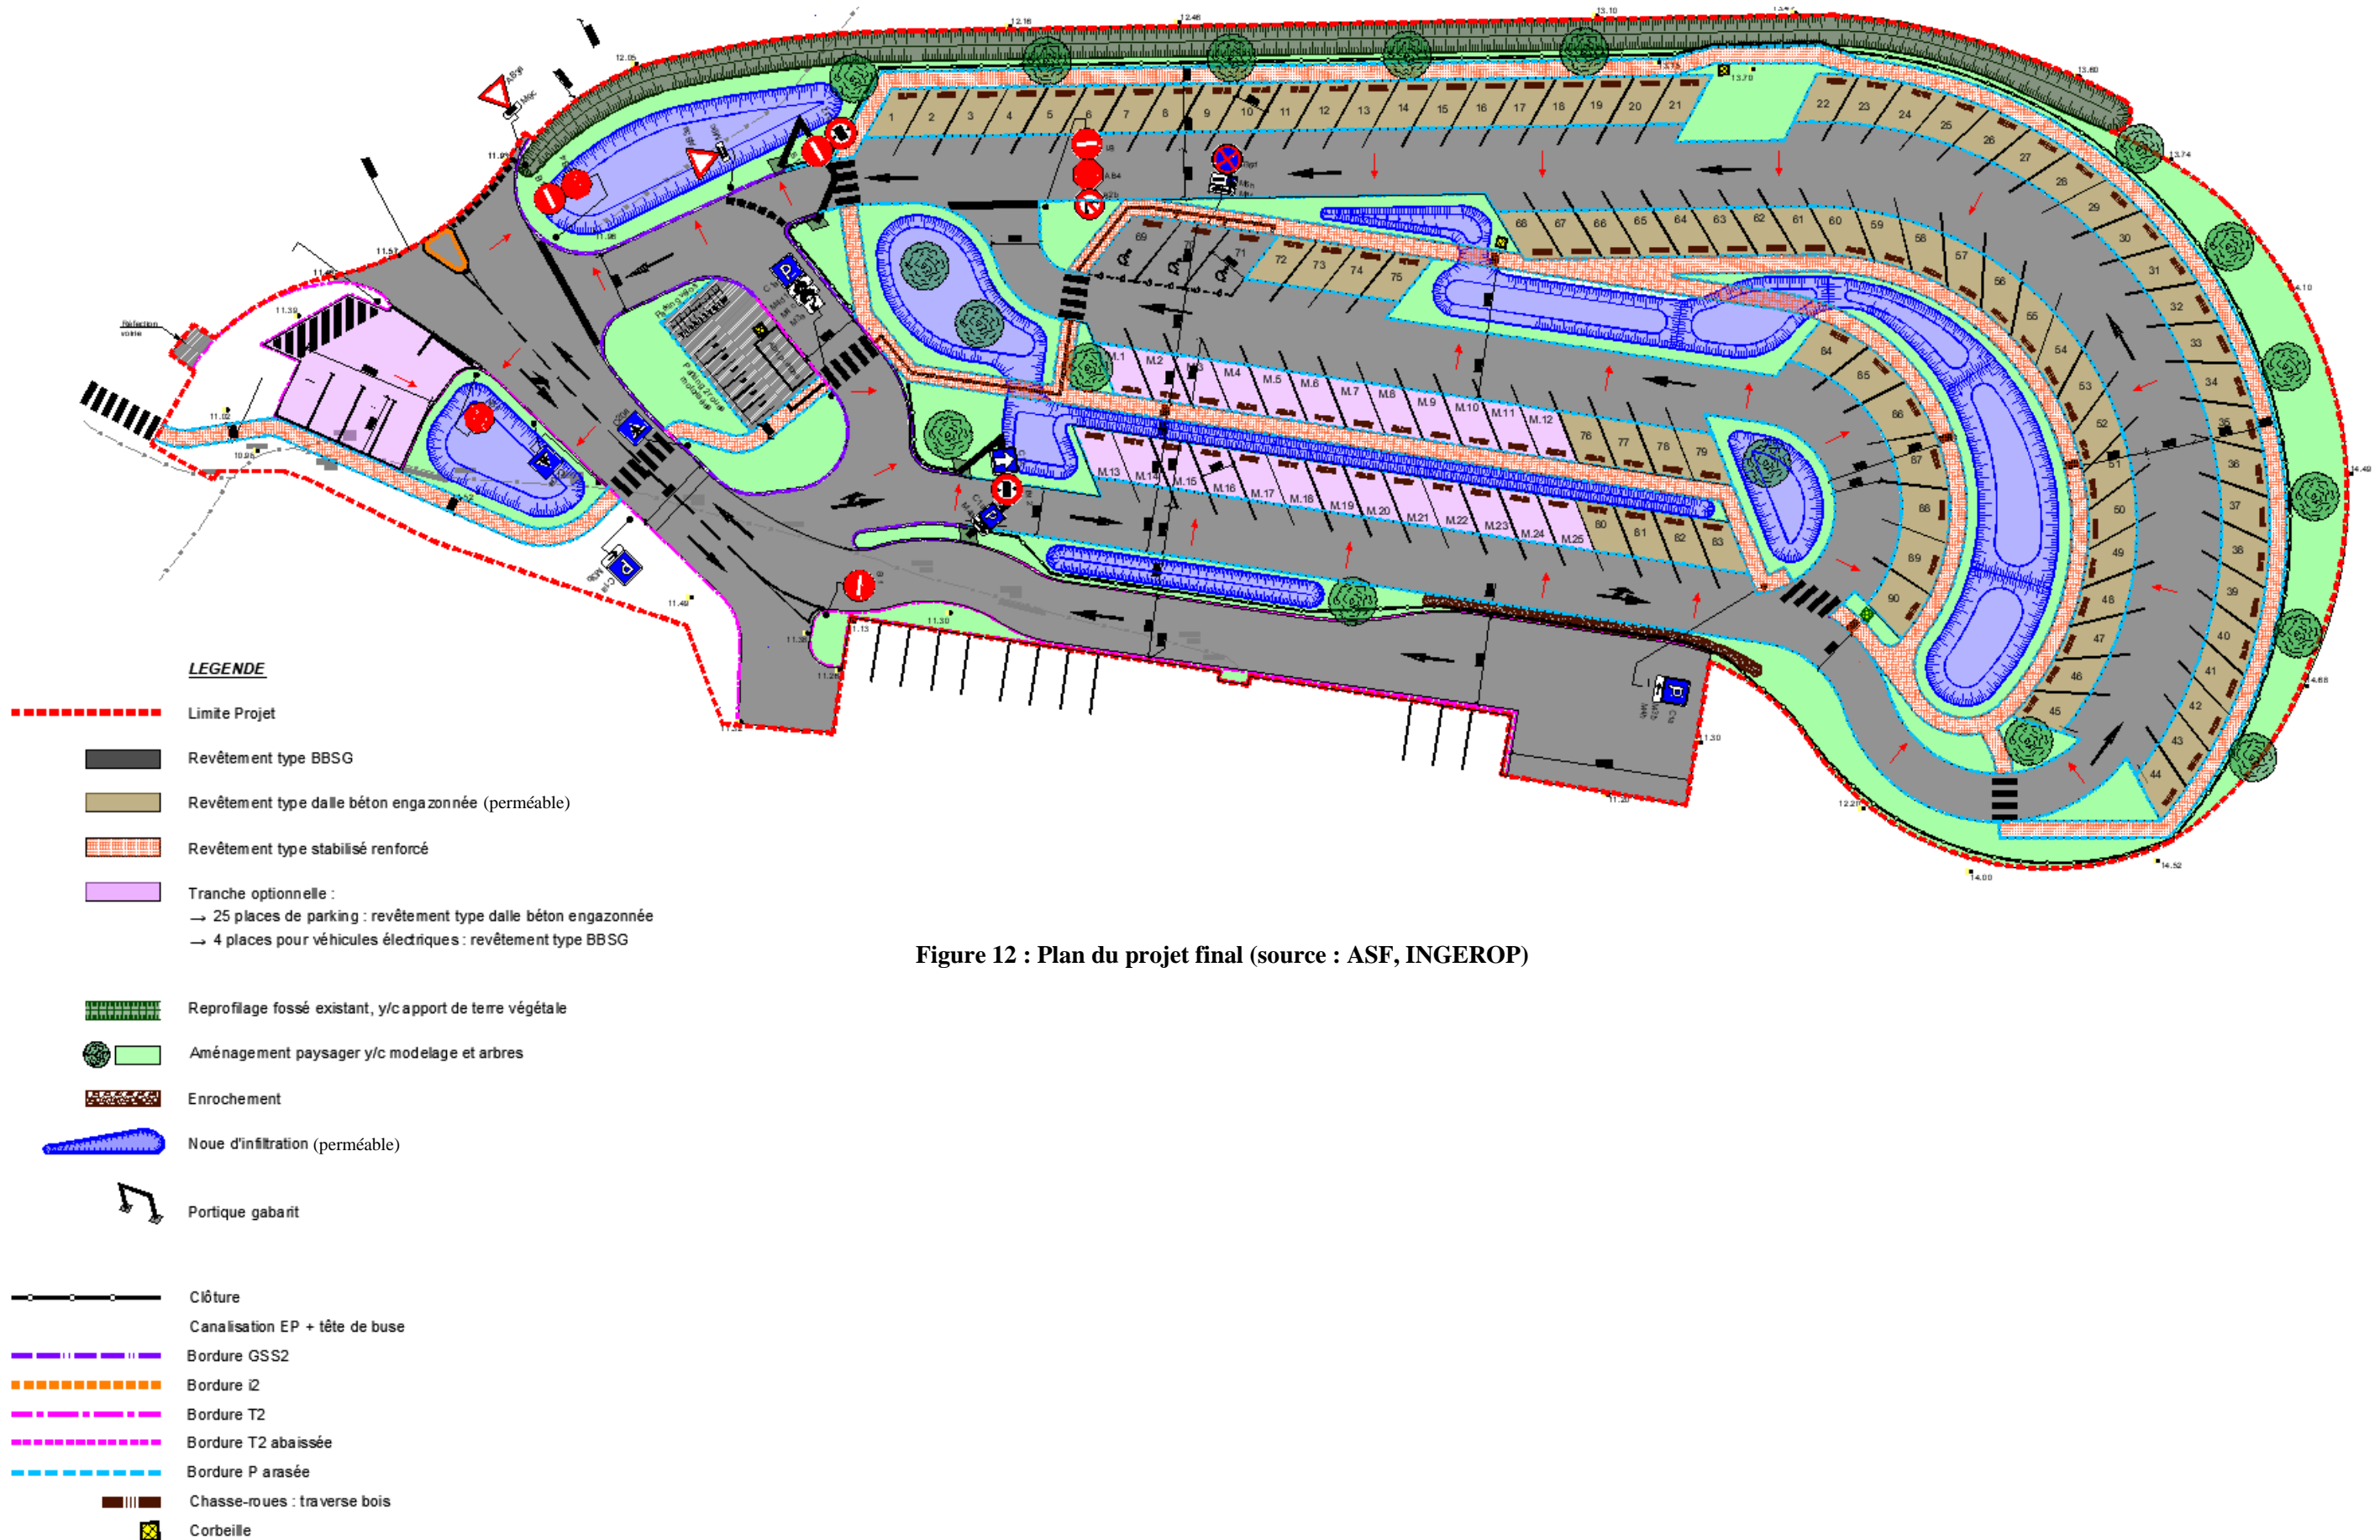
Plan du projet final (source : ASF, INGEROP)
